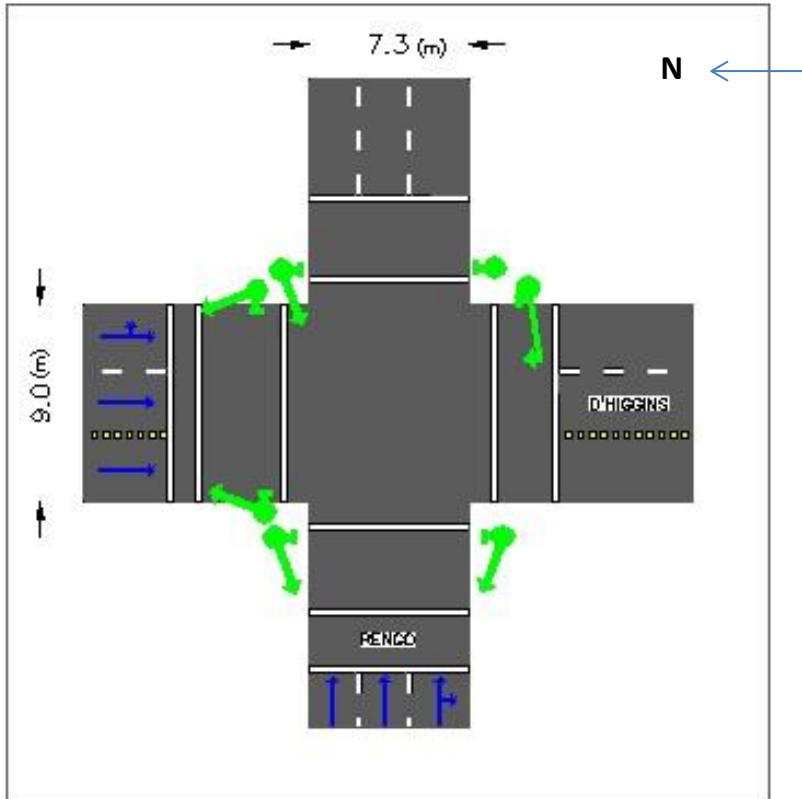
Planta intersección Bernardo O'Higgins / Rengo
